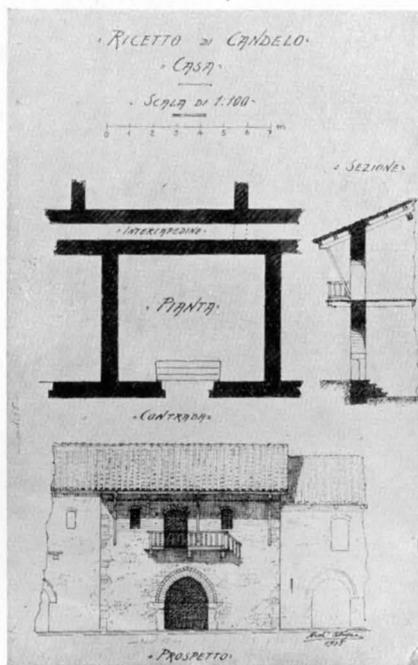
Ricetto di Candelo - Casa: pianta e prospetto.
